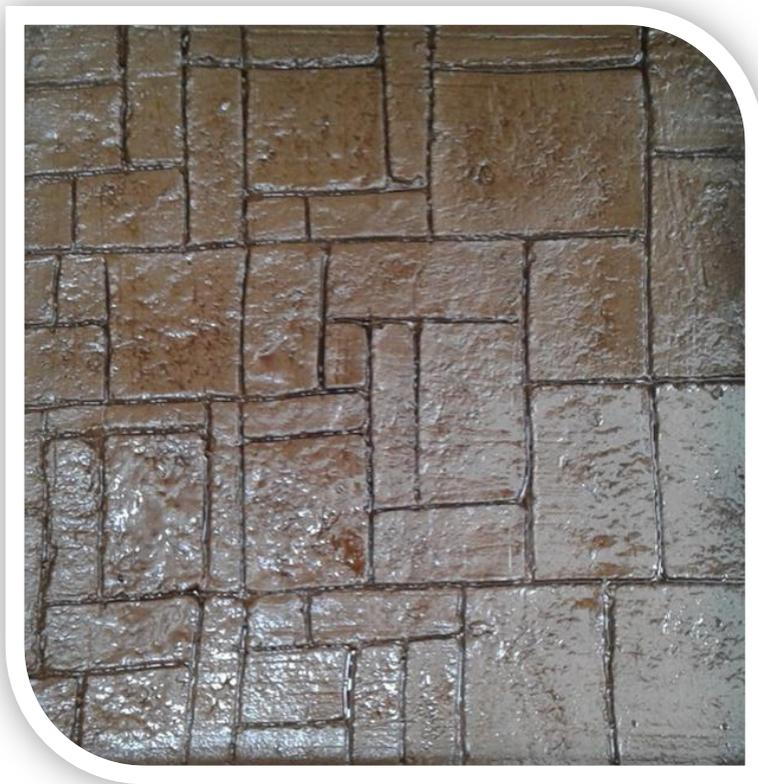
Piso Decorativo con Argamasa del Terreno y Cemento, Acabado Tipo Madera.
